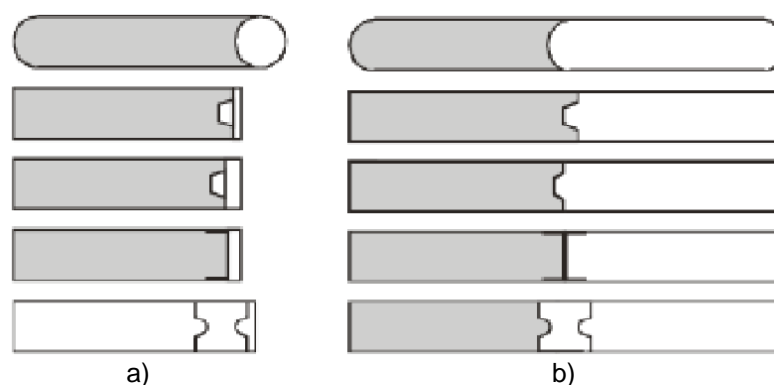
Exemplo de secções-tipo de juntas entre painéis: a) betonagem dos painéis primários; b) betonagem dos painéis secundários (Rocha, 2010).
